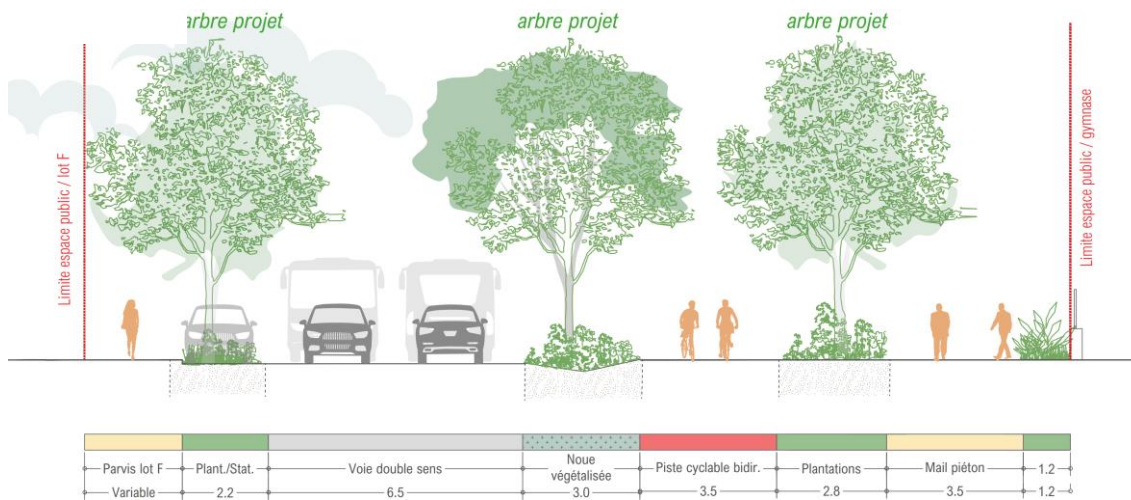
Plan de coupe au droit de l'entrée Ouest du quartier au niveau du mail piéton (La Fabrique Urbaine, 12/2024)
